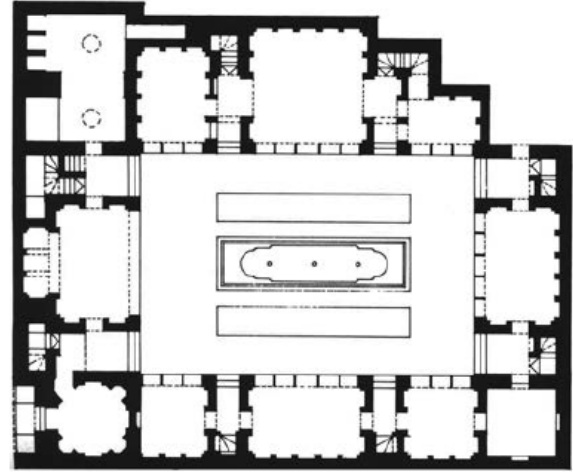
Pianta tipica ©Ahmadreza FORUZANMEHR
